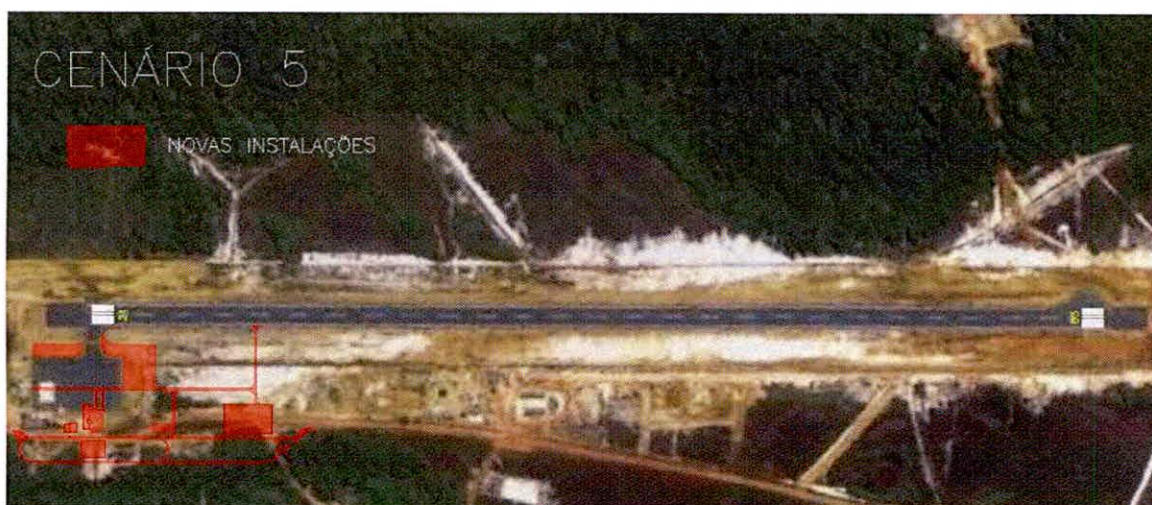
Área das novas instalações no cenário 5 (hachura em vermelho)
